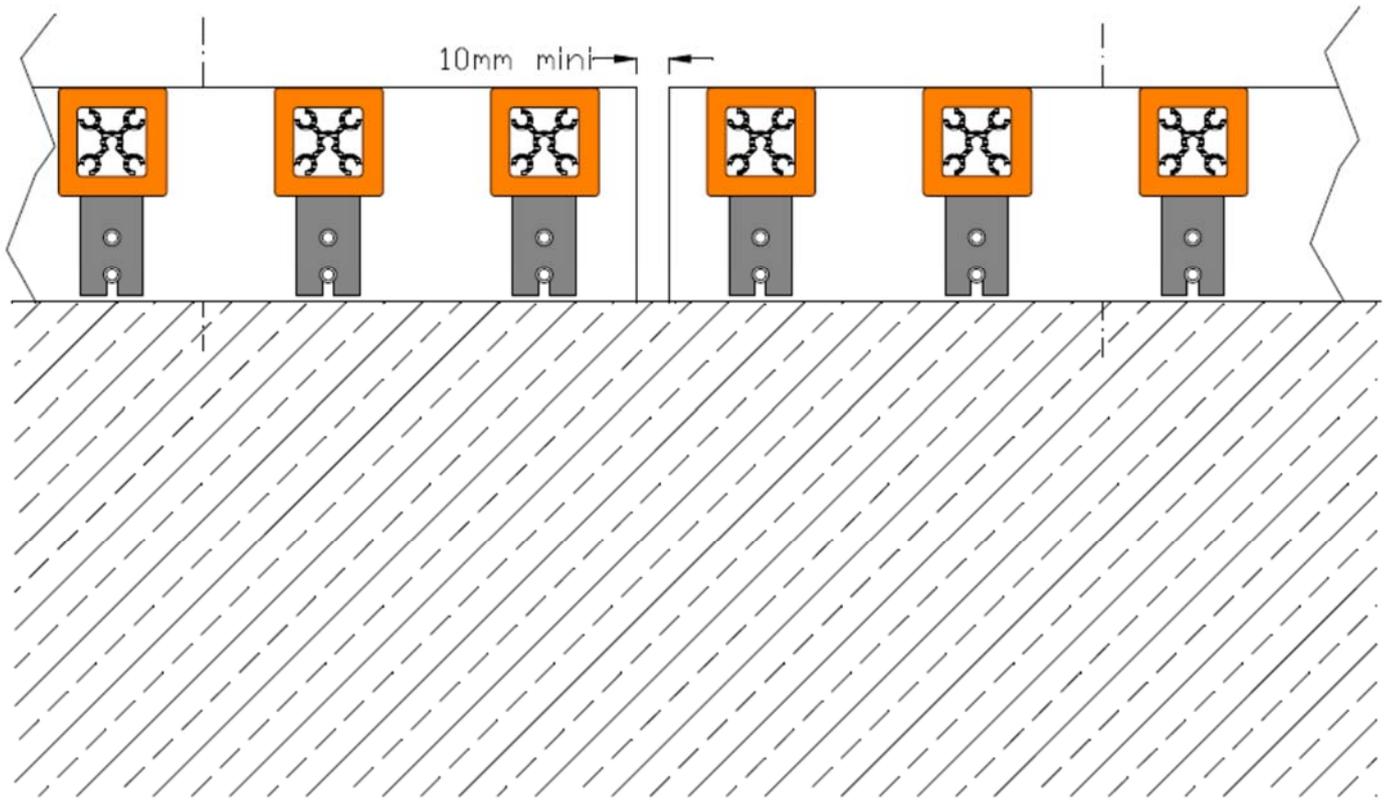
a – Pose verticale, joint de fractionnement de l'ossature avec profil de section rectangulaire
